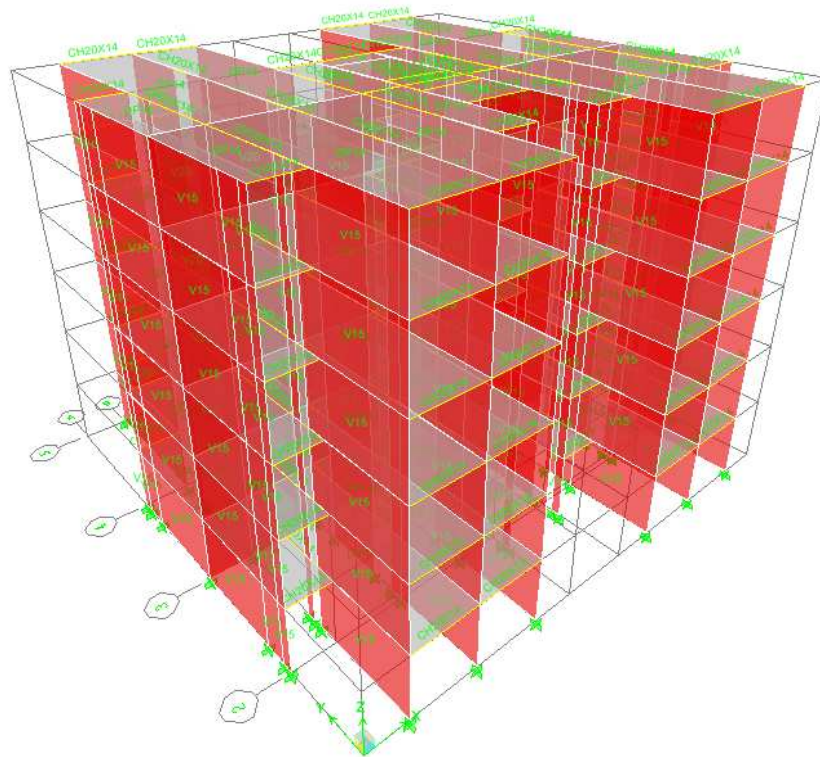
image 3D de la structure (coffrage tunnel) sur ETABS
